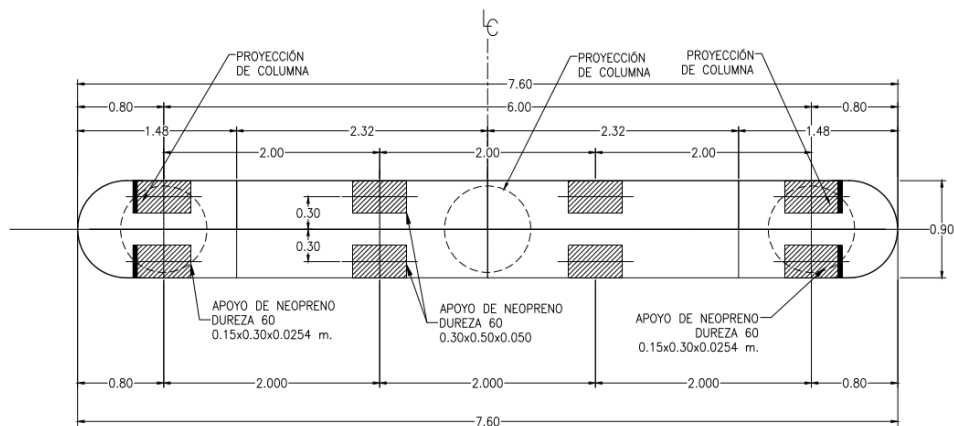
Detalle de planta de niveles y ubicación de neopreno, 2ds calle.
